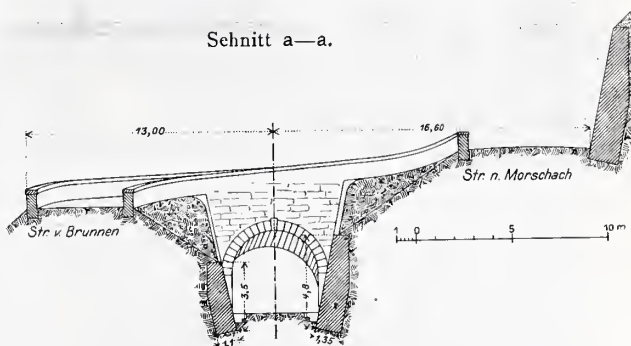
Gewölbte Strassen-Ueberführung im Bau.
